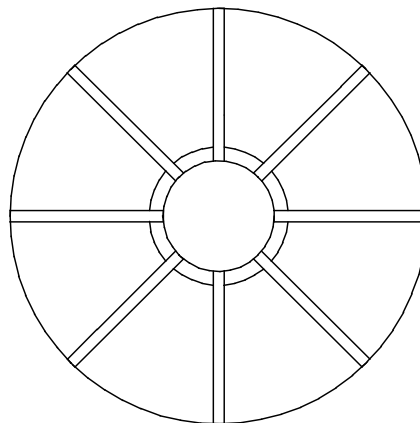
Planta de una losa hormigonada con nervios radiales
